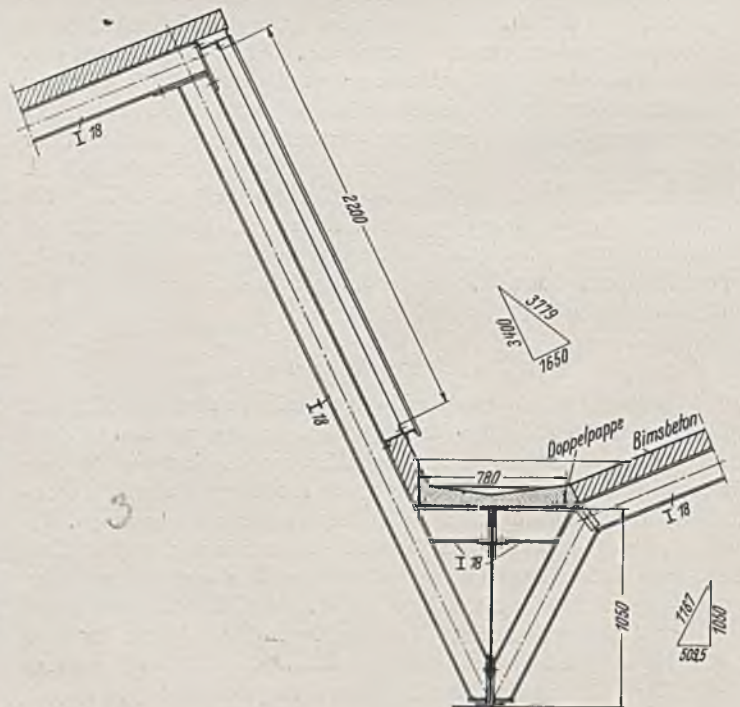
Bau 6 und Bau 7: Normale Dacheinheit.
